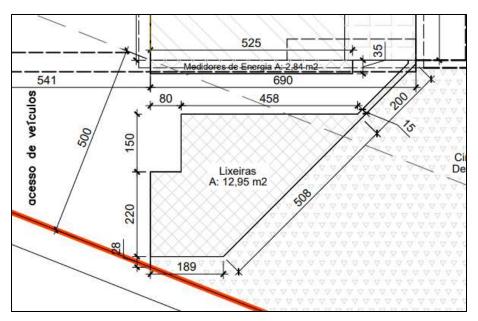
Recorte da Planta de Implantação. Localização da lixeira.
